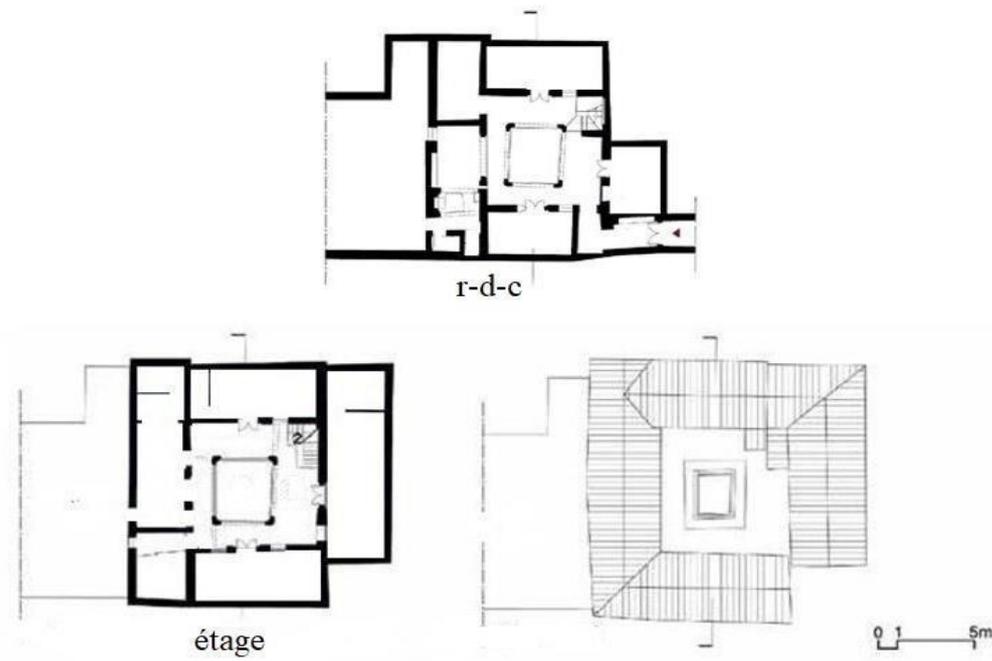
plans de la maison al- Ḥadri<sup>1</sup>
